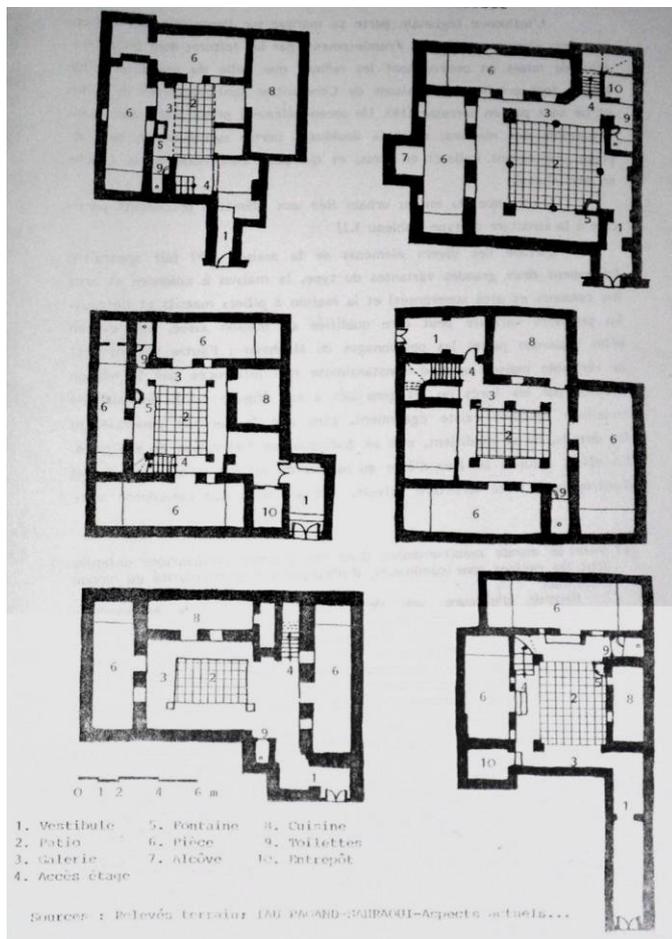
Exemples de maison traditionnelle constantinoise : plan de rez de chaussée
